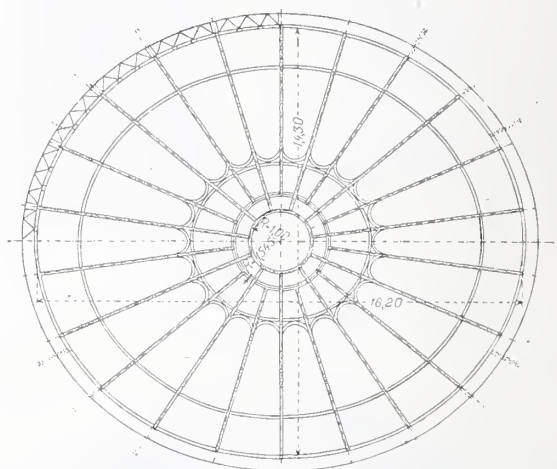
Grundriss der Calotte. — Masstab 1:250.
